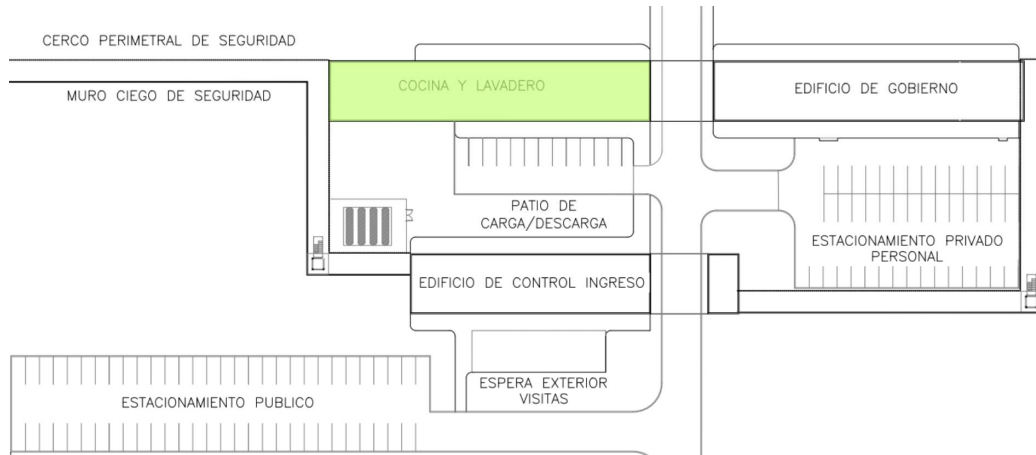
Edificio elegido para diseño y cálculo de estructura.
